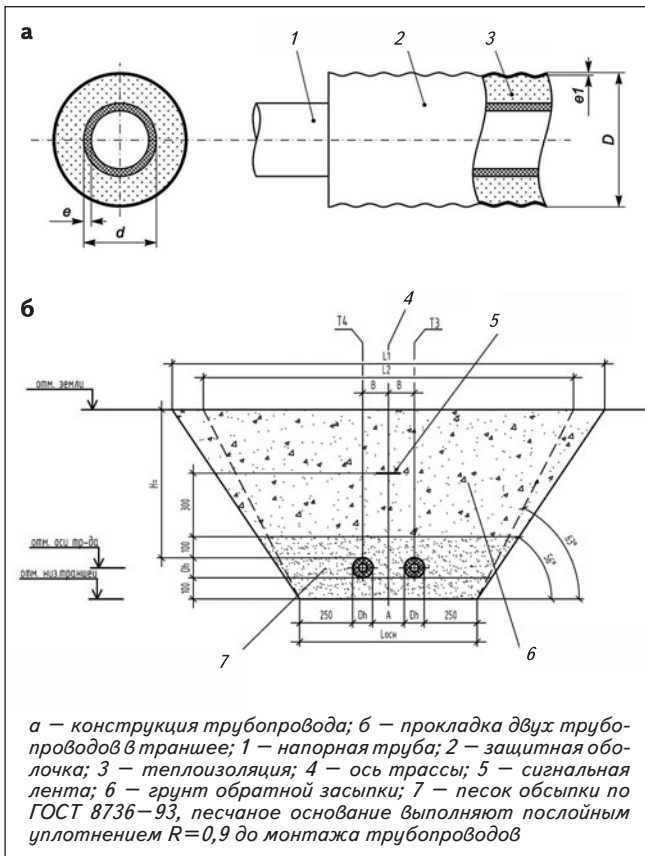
Бесканальная прокладка трубопроводов системы горячего водоснабжения
